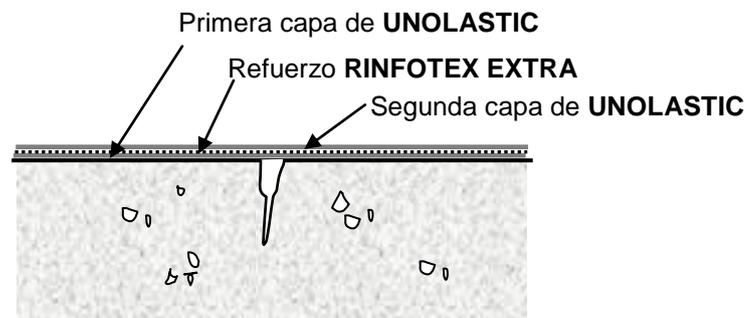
Fisuras o grietas menores de 2 mm.
